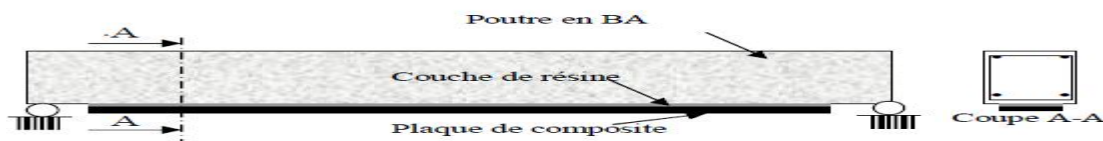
Renforcement par une Plaque de composite collée sur une poutre en BA
